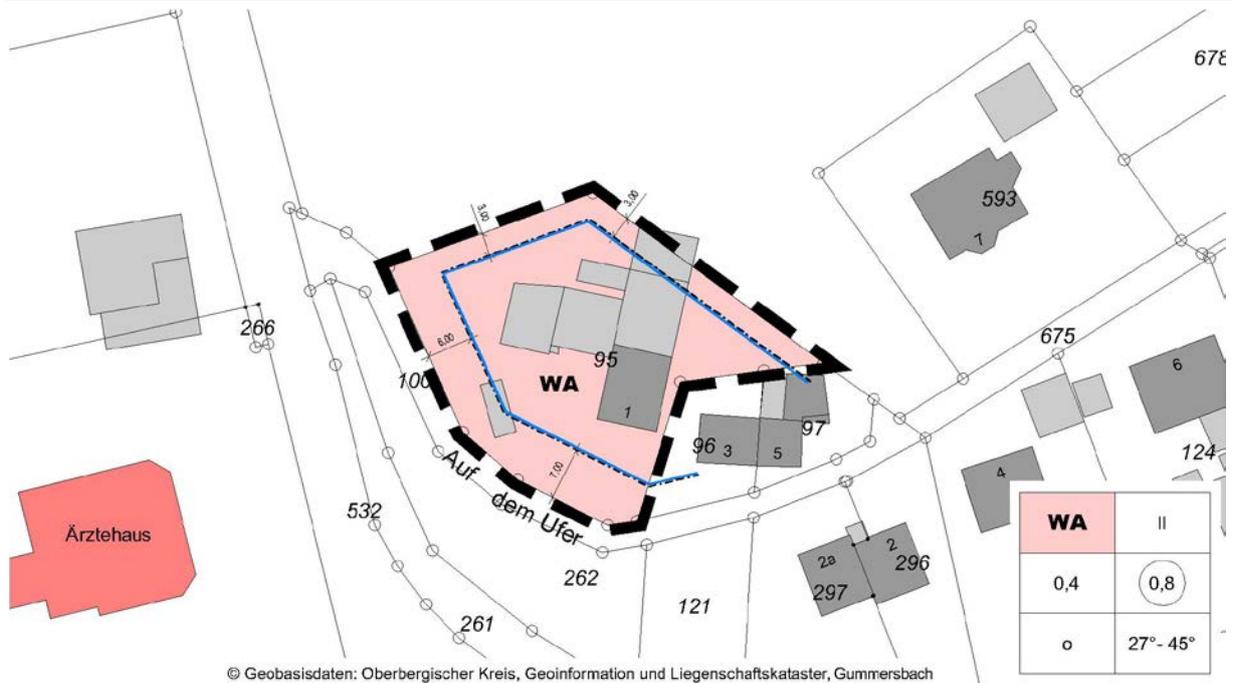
Bestehender Bebauungsplan Nr. 20 D, ohne Maßstab
